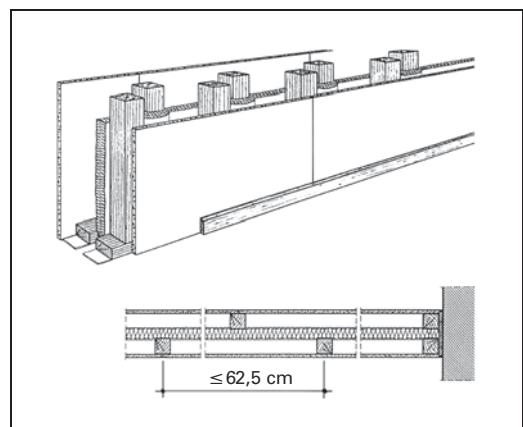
Holzdoppelständerwand, einfach beplankt
